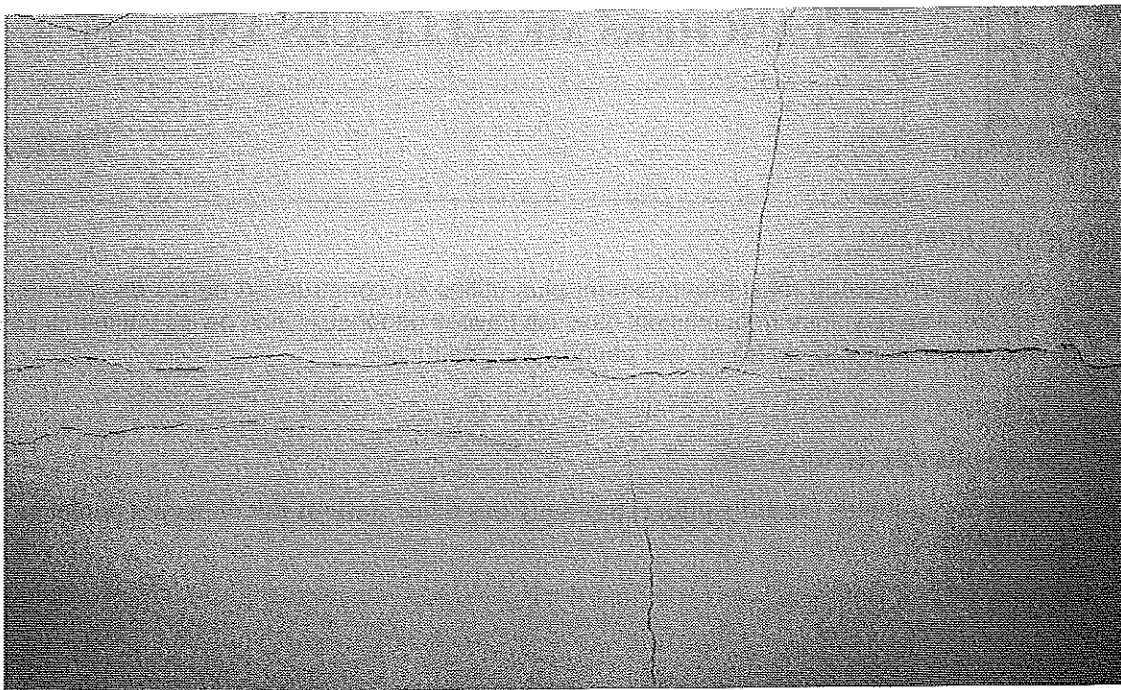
Cas de fissuration double au droit d'une poutrelle porteuse. Présence d'une fissure perpendiculaire dans une zone centrale. © J. Putatti
